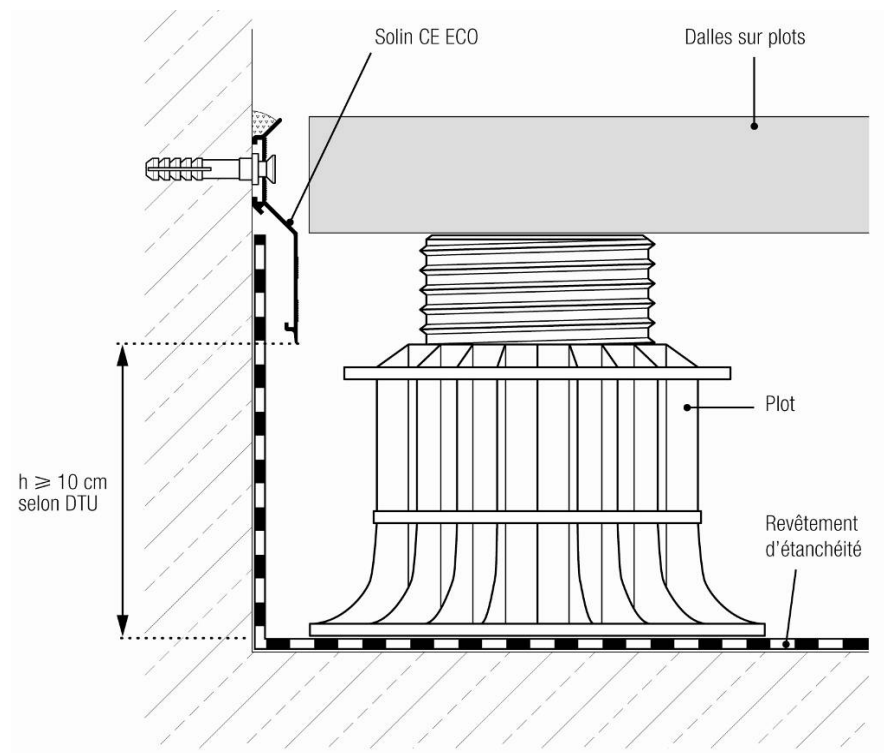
Toiture-terrasse accessible aux piétons et au séjour avec dalles sur plots et niveau fini des dalles au-dessus du haut des relevés
